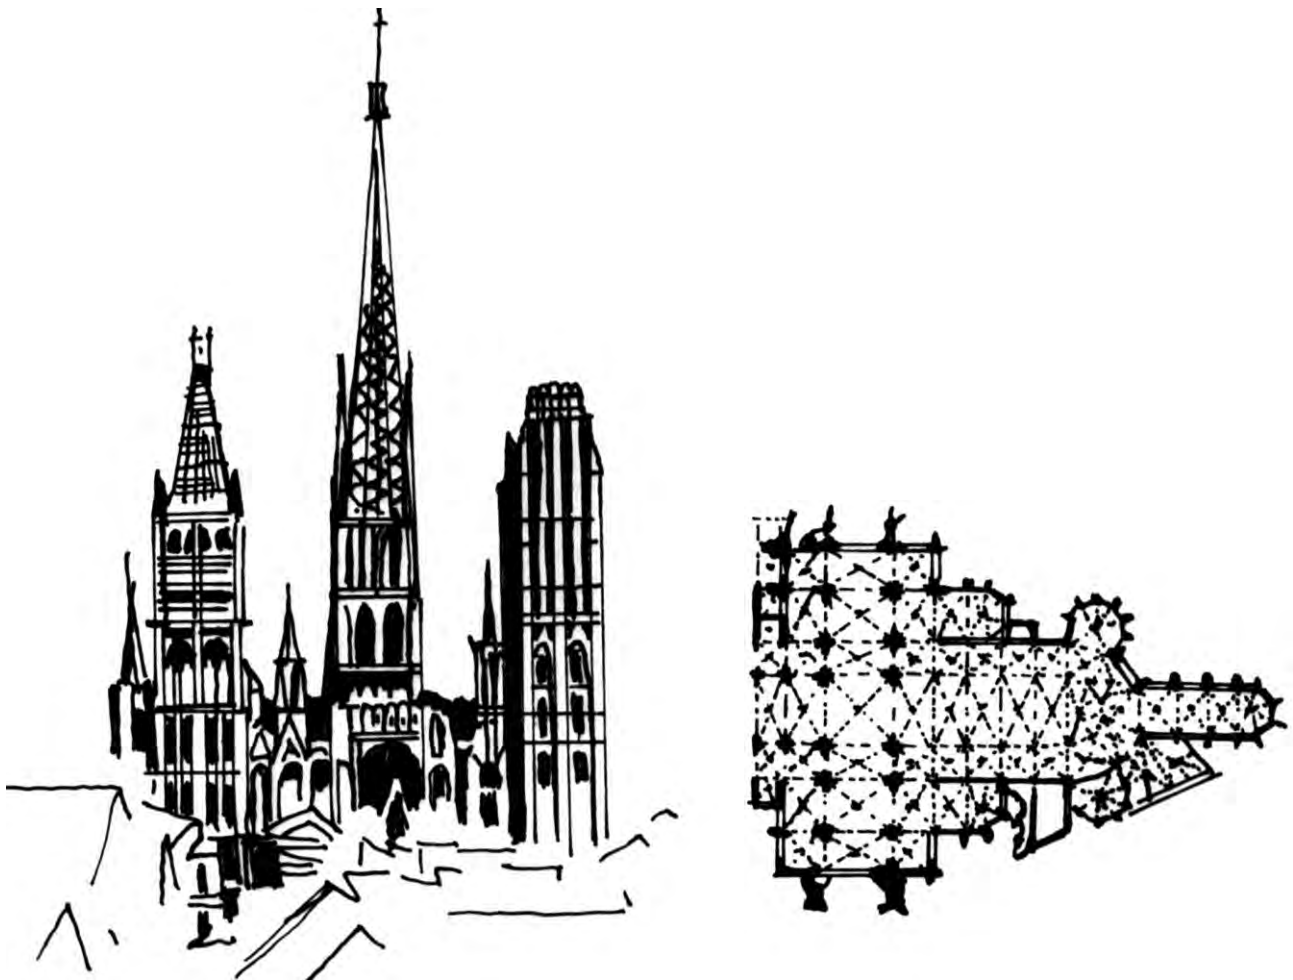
Руан. Собор. XIII–XV вв. План и фасад
